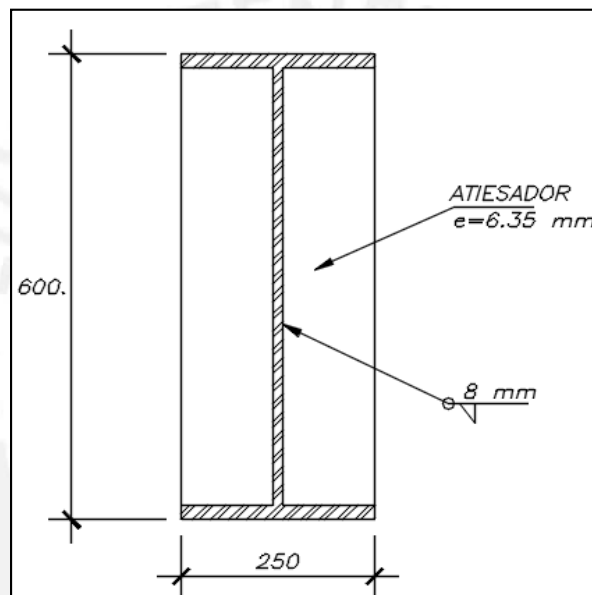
DETALLE DE INSTALACIÓN DE ATIESADOR EN VIGAS DE ACERO
